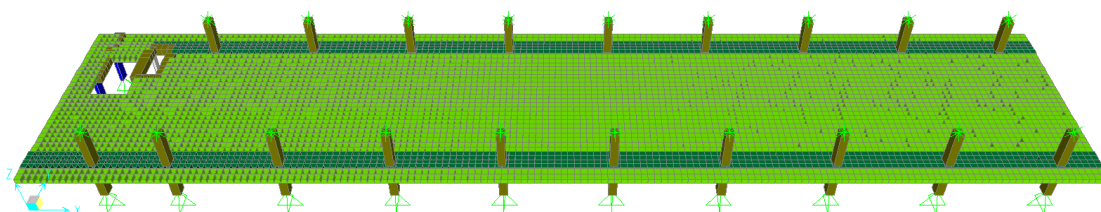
Modelo tridimensional de uma laje de piso elevado.
